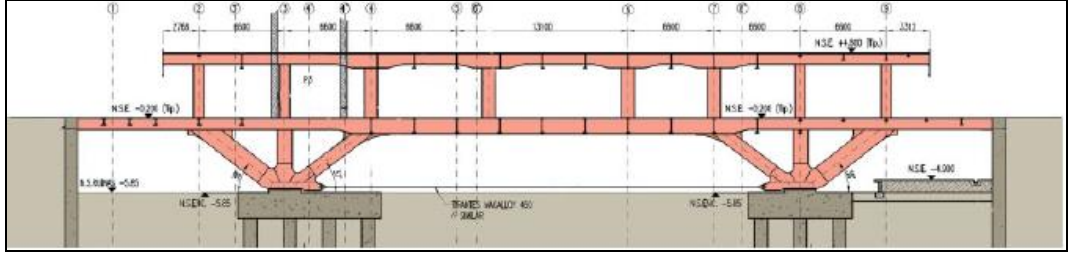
Yapıyı oluşturan bölümleri gösteren kesit (Caneparo, 2014)
